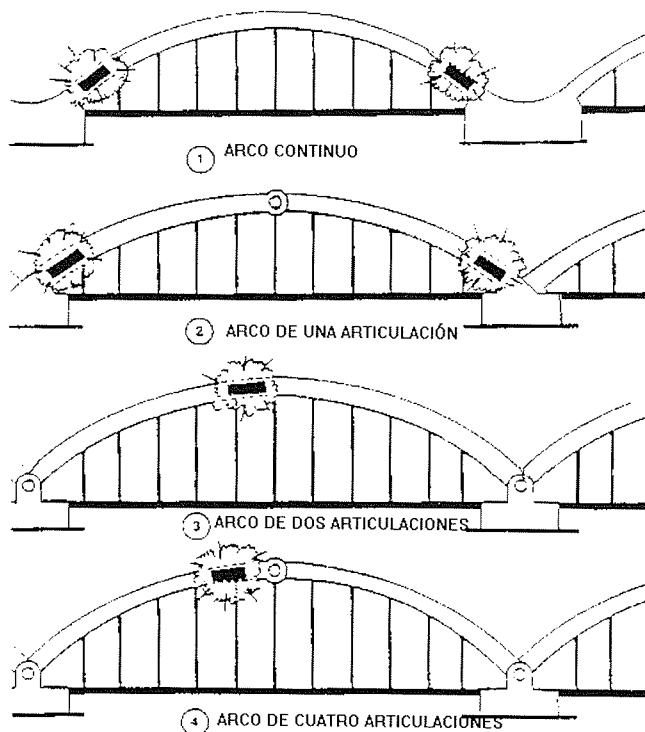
Colocación de cargas en puentes de arcos de acero
